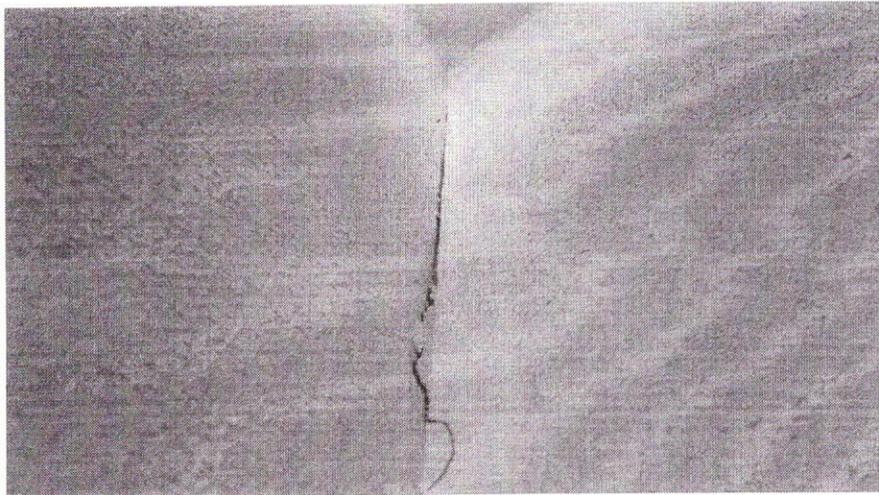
Imagem com vista da área interna do prédio do bloco 11 onde podem ser observadas fissuras em decorrência da movimentação na fundação.
